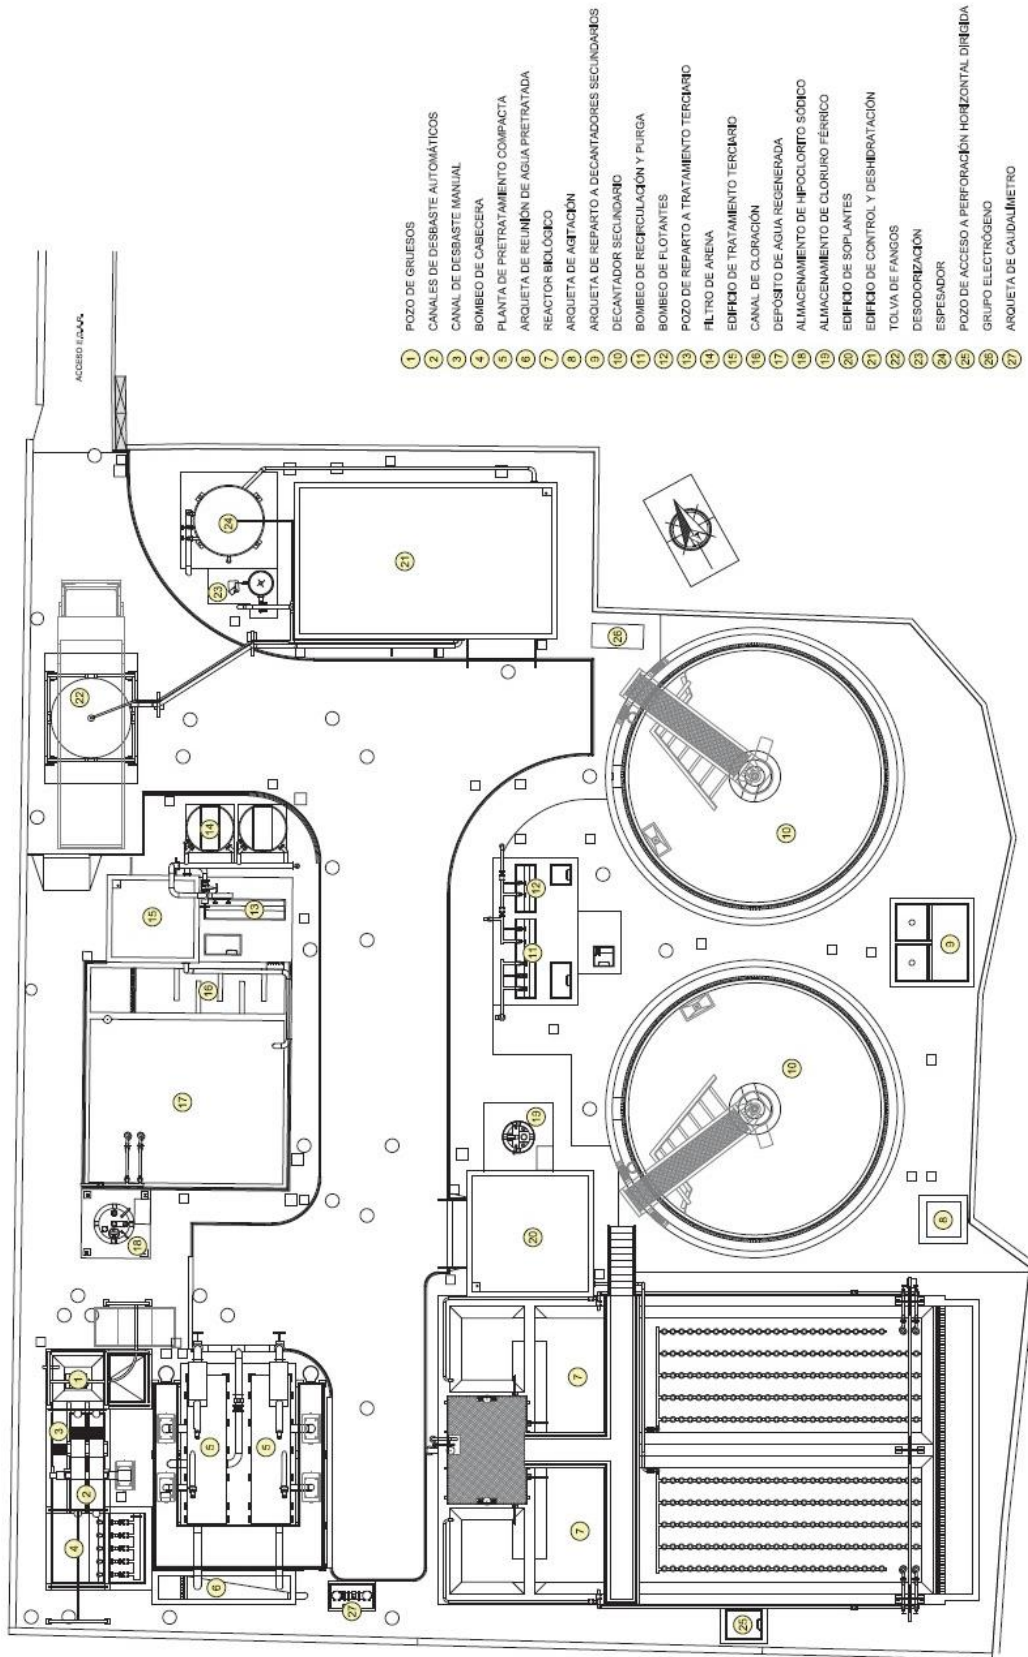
VISTA EN PLANTA DE LA EDAR DE CALVIA
